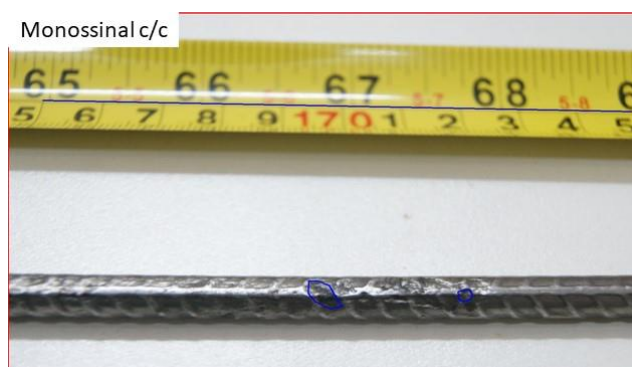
áreas superficiais corroídas do vergalhão da viga monossinal c/c – parte 2
